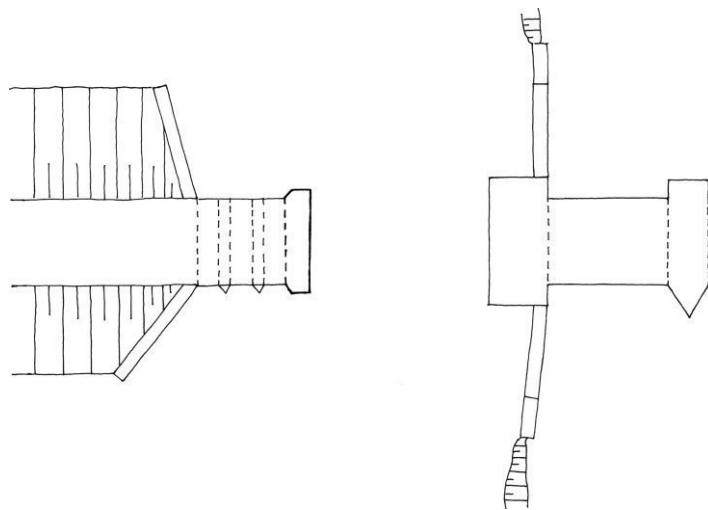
Dibujo de la planta de cómo quedarán la alcantarilla y el estribo de la M.I.
